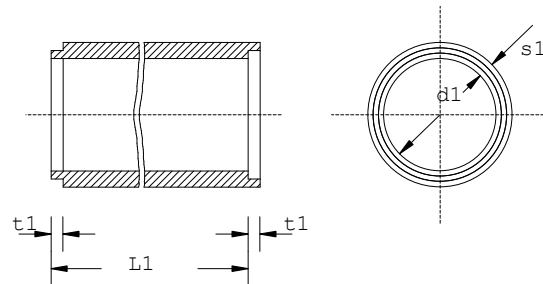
Tubi in calcestruzzo di sezione circolare con giunto a risega senza piede
